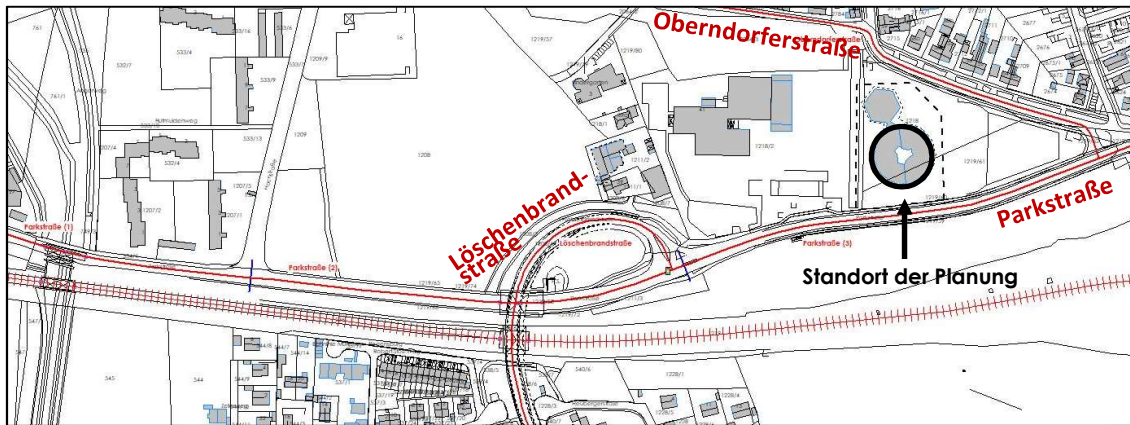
Lageplan mit Darstellung der relevanten Straßen und des Standorts der Planung
